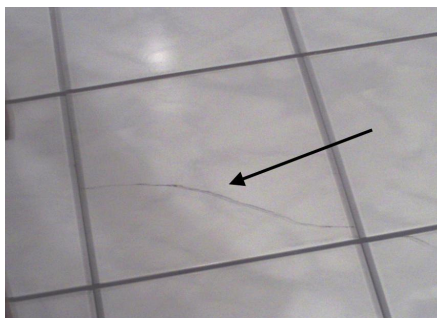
Fissuras no revestimento cerâmico.
